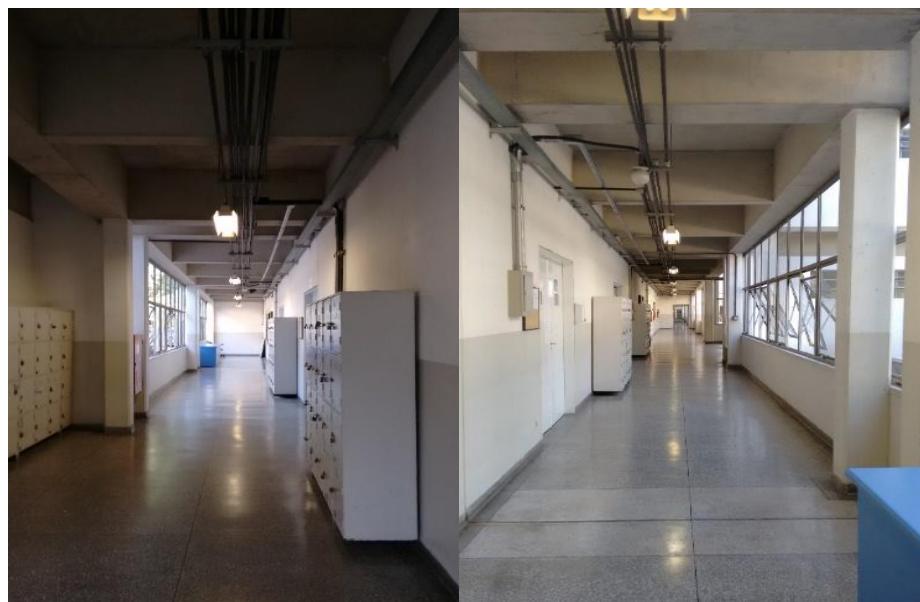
Fotos à esq. Fachada NE; à dir. Fachada SO
